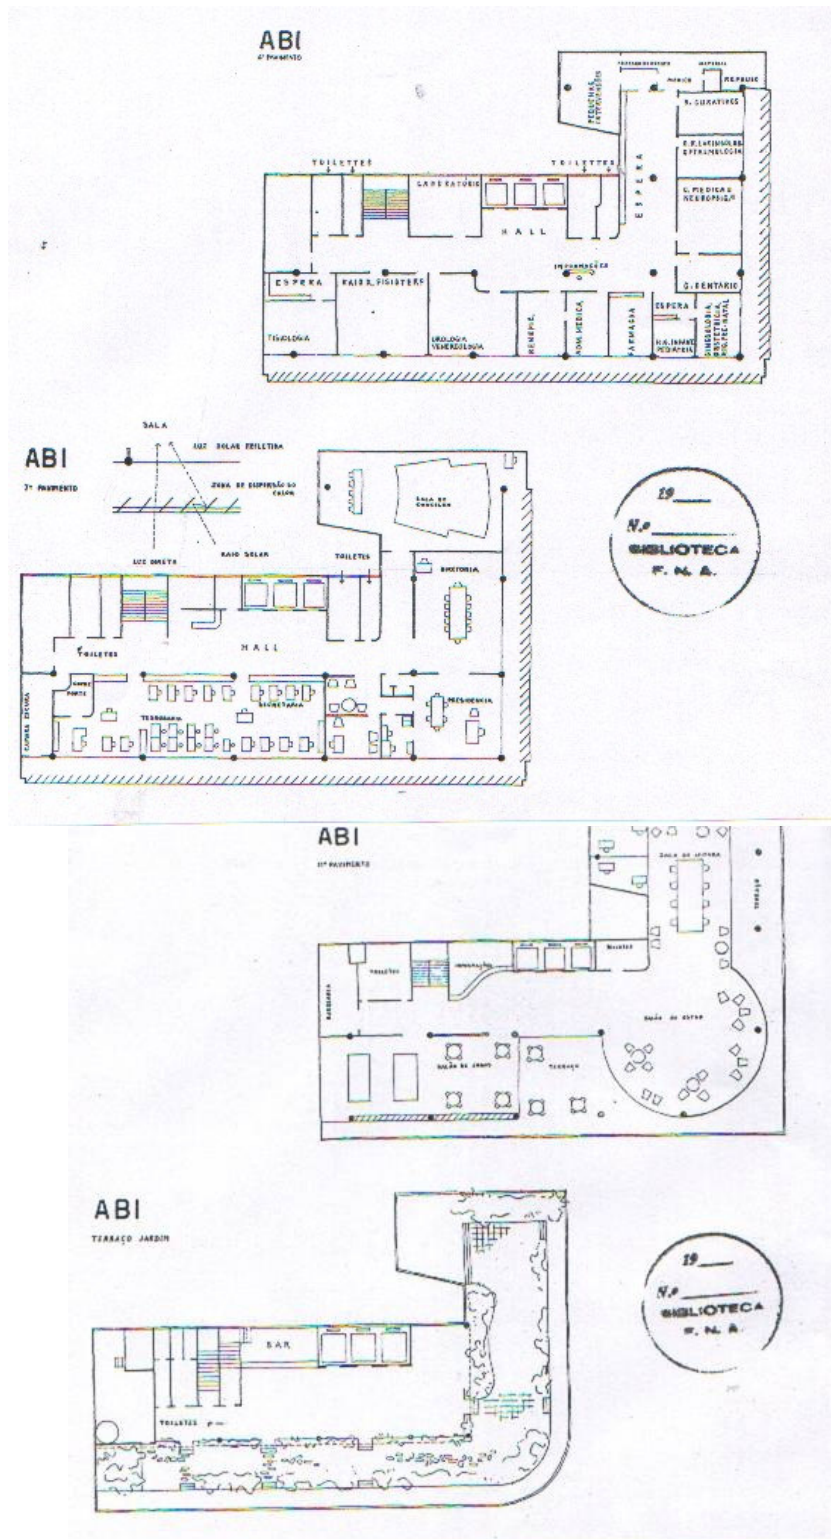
plantas baixas ABI (de cima para baixo: 4º pav., 3º pav. [diretoria], 11º pav. [salas jornalistas], terraço jardim)
